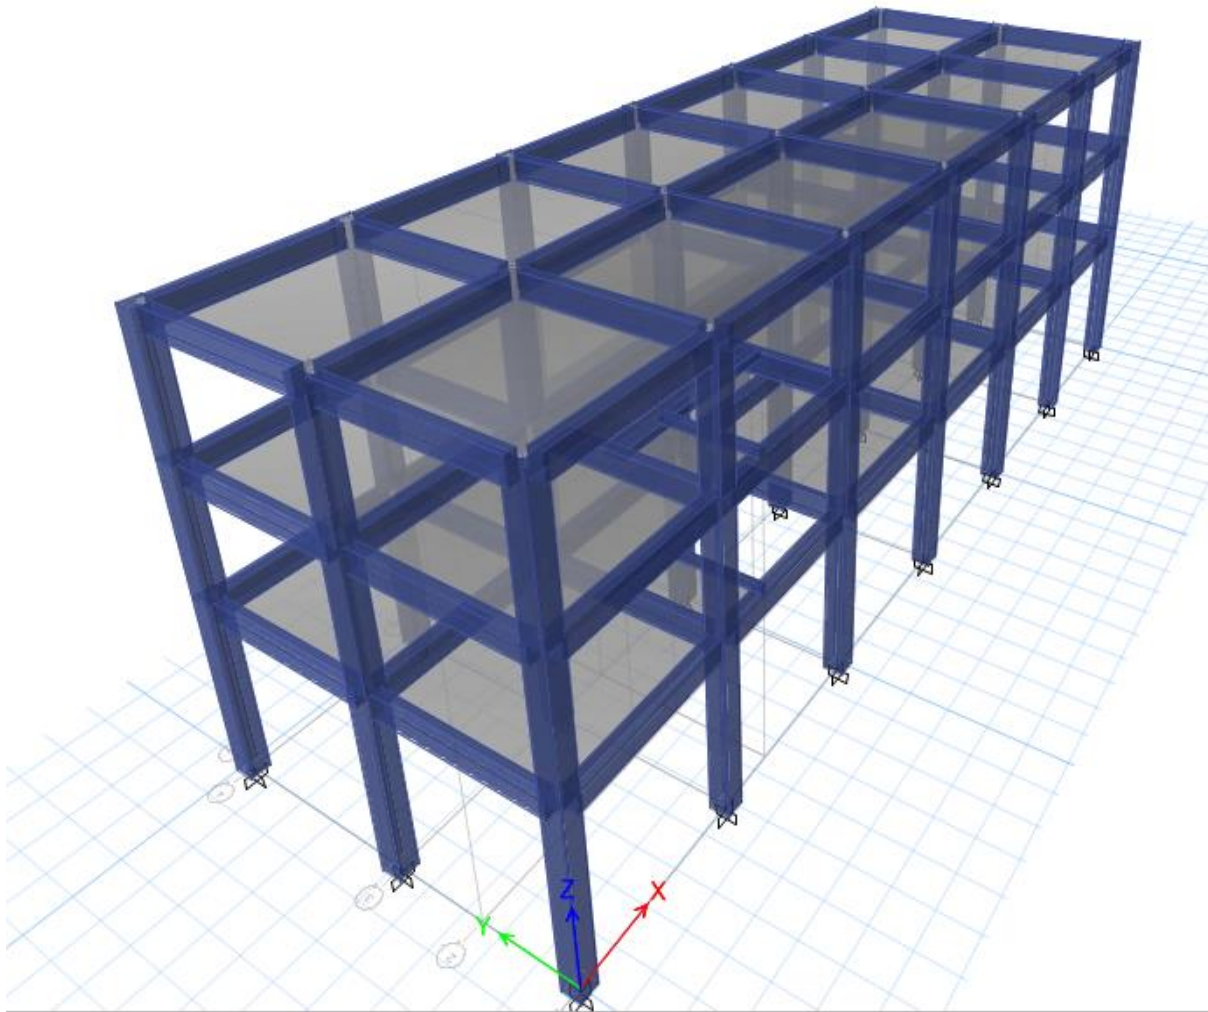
Modelo estructural de la edificación con sistema aporticado.
